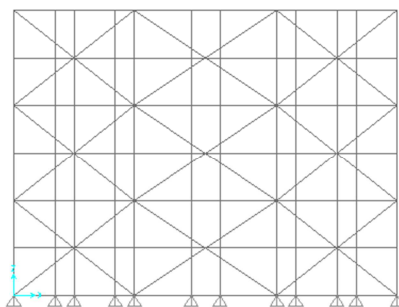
Configuração dos Planos de Contraventamento Vertical Com Elementos de Contraventamento Grandes
